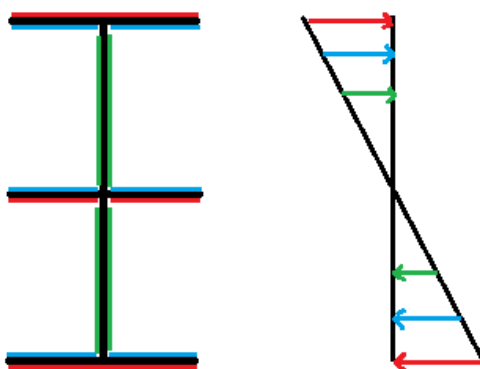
Tipos de soldadura y diagrama de cortantes
